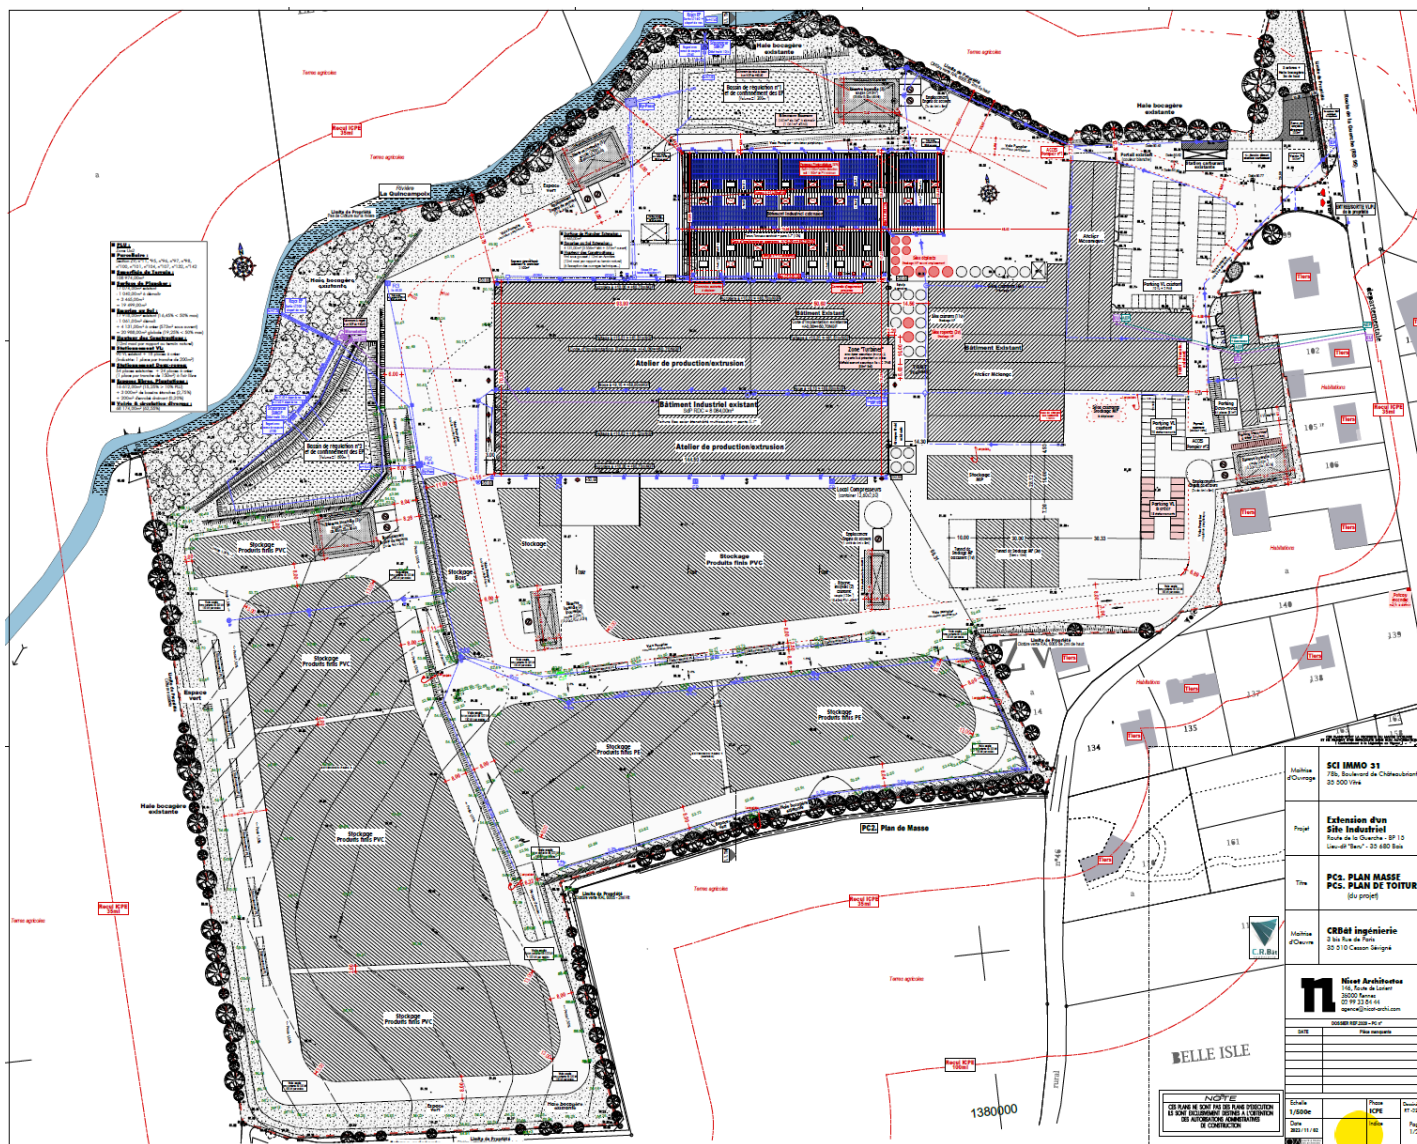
Plan masse du projet (Source : Nicot Architecte)
